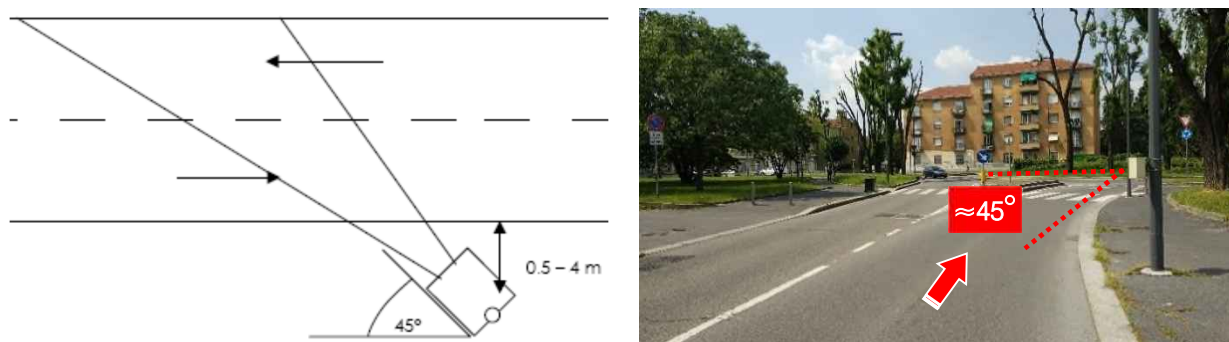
Angolo di installazione dei radar rispetto alla direzione di marcia
